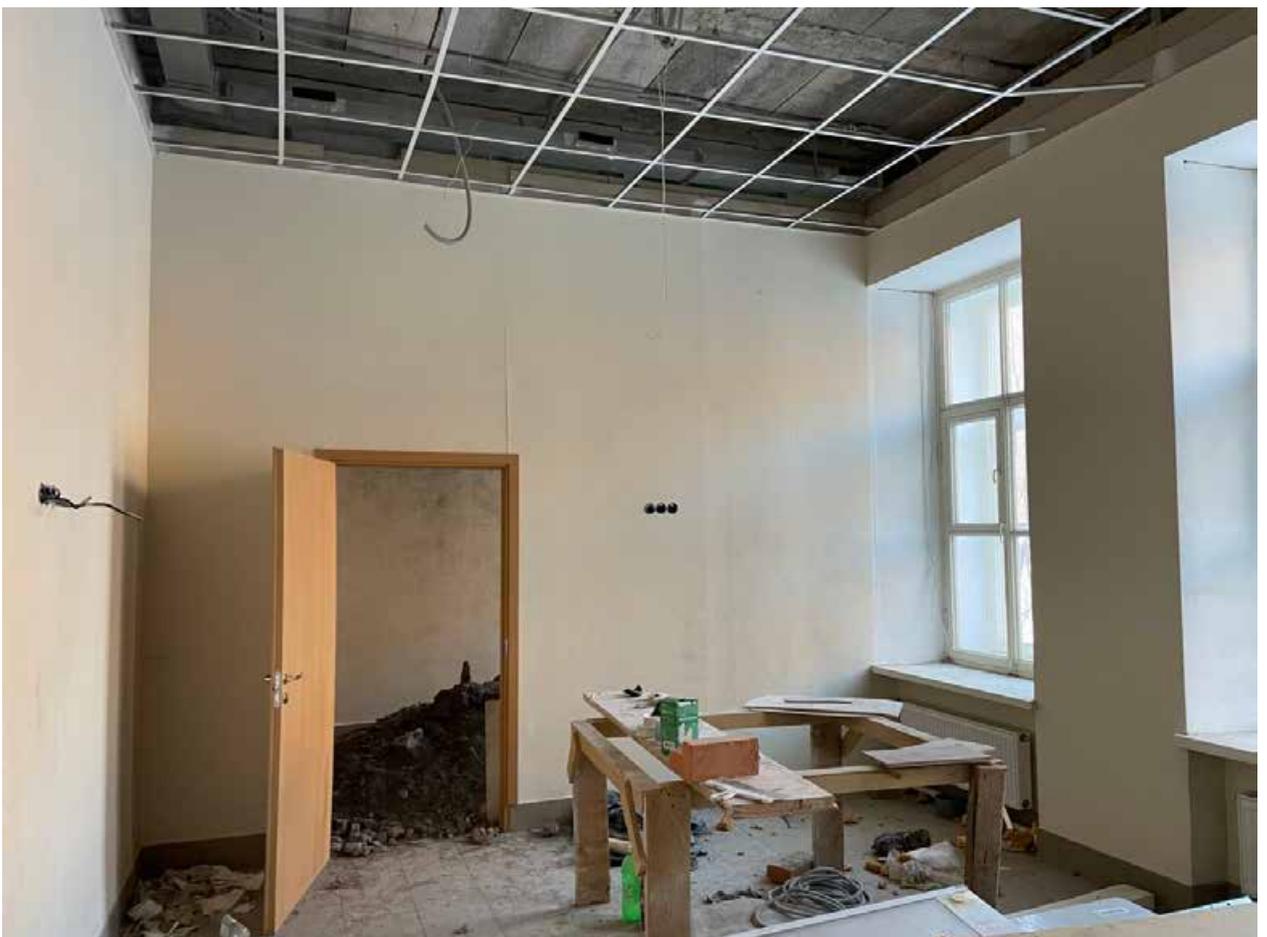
1 этаж. Помещение по западному фасаду.
